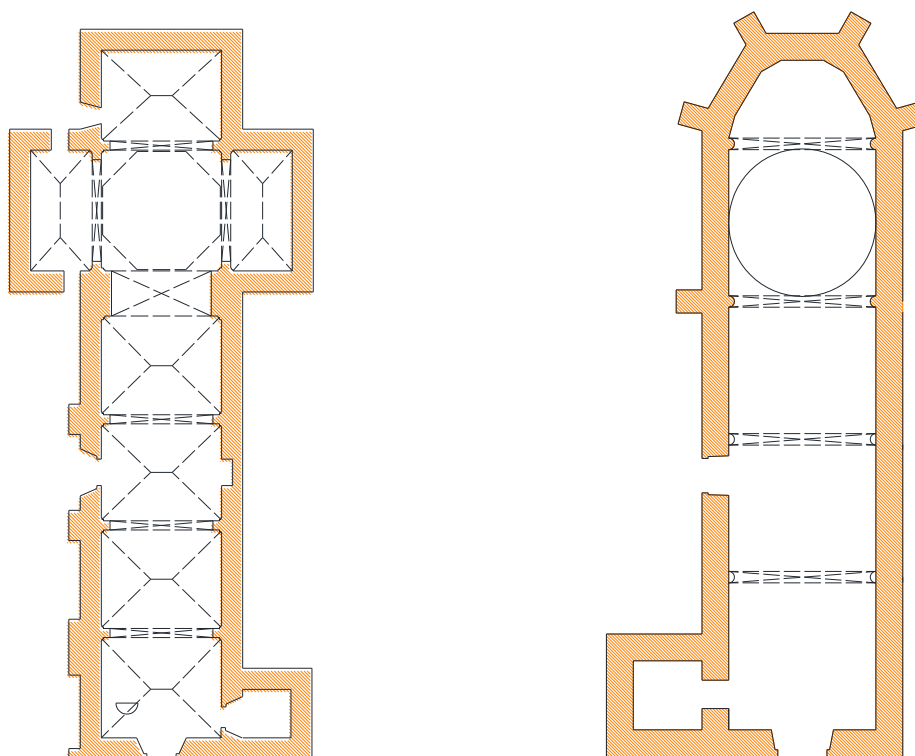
Plantas de los diferentes modelos parroquiales. Derecha nave de planta en de cruz latina, izquierda nave de planta rectangular.
